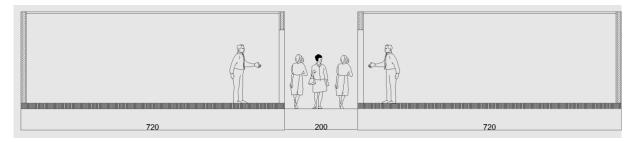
Potongan dan denah koridor yang sudah terkurangi areanya oleh keberadaan PKL
